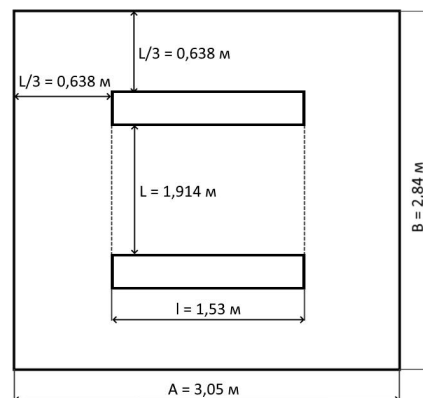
План помещения и размещения светильников люминесцентными лампами
